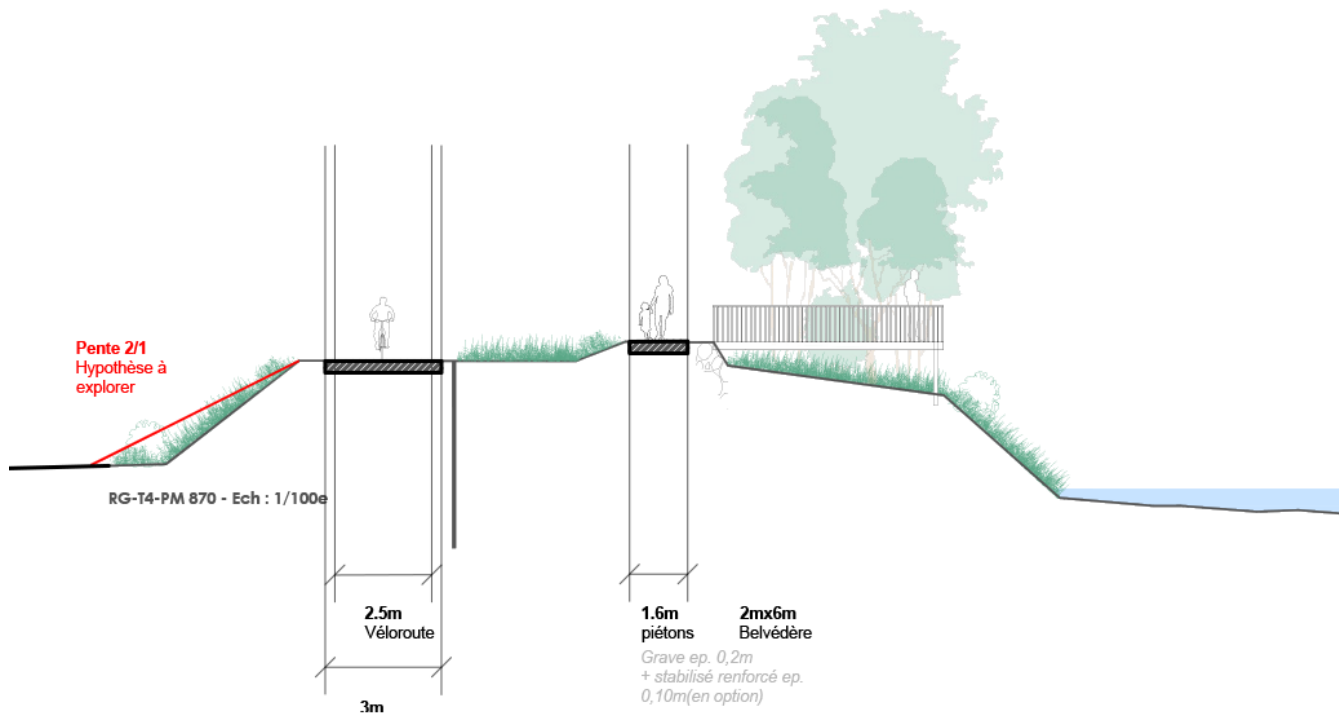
Profil 870 RG-T4 en amont du pont de Tucinge (Avenue Ravel)
